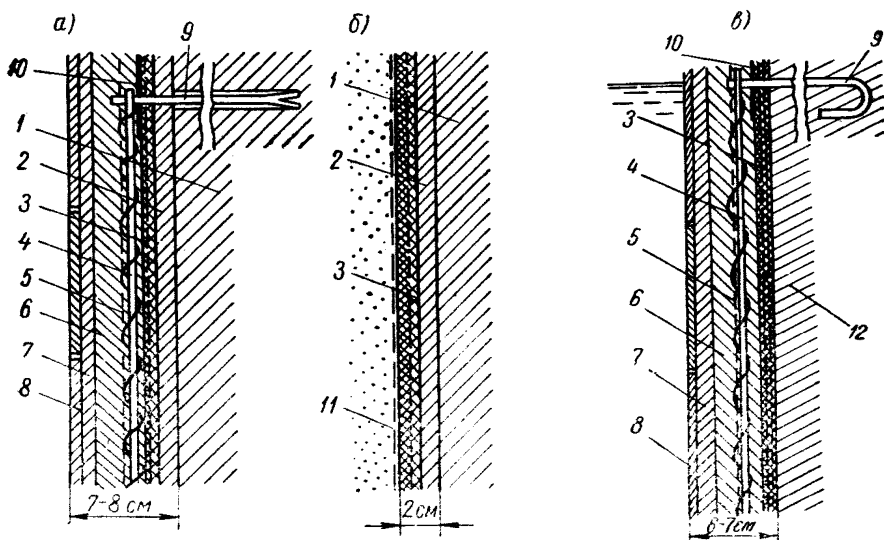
Конструкция пароизоляции и гидроизоляции на стенках помещений и бассейнов.
